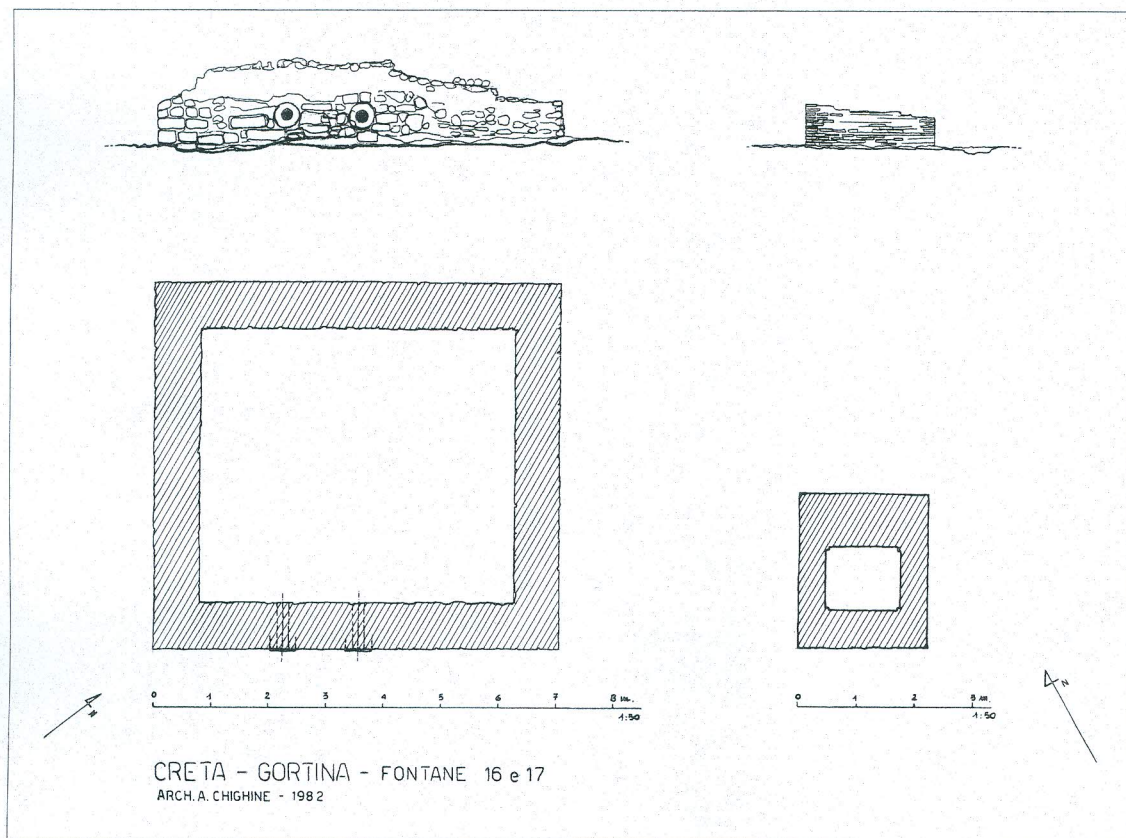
PIANTE E PROSPETTO SUD DELLE FONTANE NN. 16 E 17 (ril. arch. A. Chighine).
